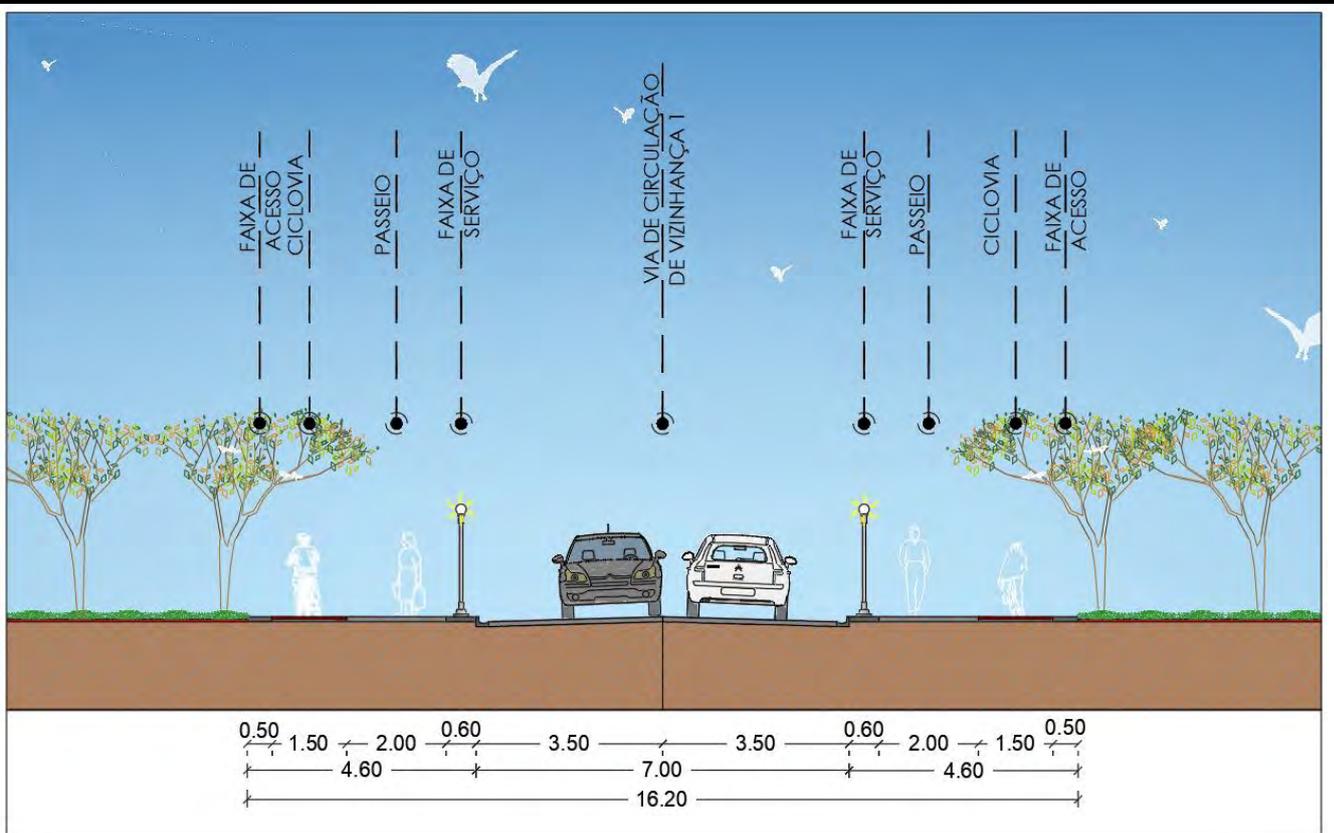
Perfil 1 - Via de Circulação de vizinhança 1
